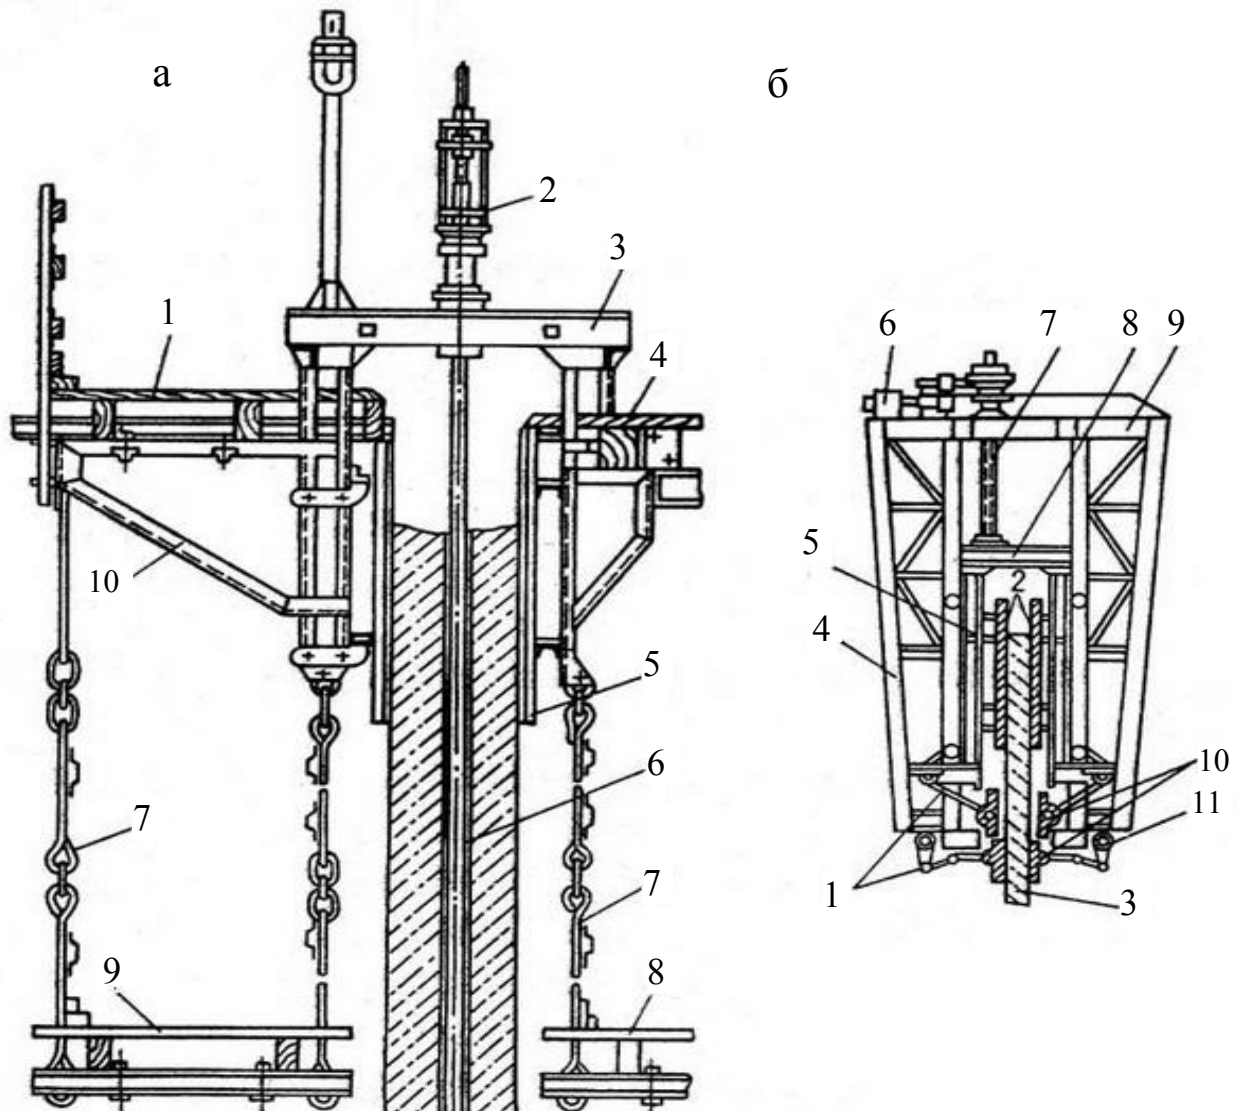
Улаштування вертикальної ковзної опалубки: а – з домкратними стрижнями: 1, 9 – зовнішнє риштування; 2 – гідродомкрат з регулятором горизонтальності; 3 – домкратна рама; 4 – робоча підлога; 5 – щит опалубки; 6 – домкратний стрижень; 7 – підвіски; 8 – внутрішнє риштування; 10 – кронштейн; б – з опорними пластинами: 1 – бетонована стіна; 2 – опалубні щити; 3 – важелі; 4 – опорна зовнішня рама; 5 – піднімальна внутрішня рама; 6 – привід гвинтового підняття; 7 – гвинт; 8,9 – ригелі піднімальної і опорної рам відповідно; 10 – опорні пластини; 11 – притискний пристрій
